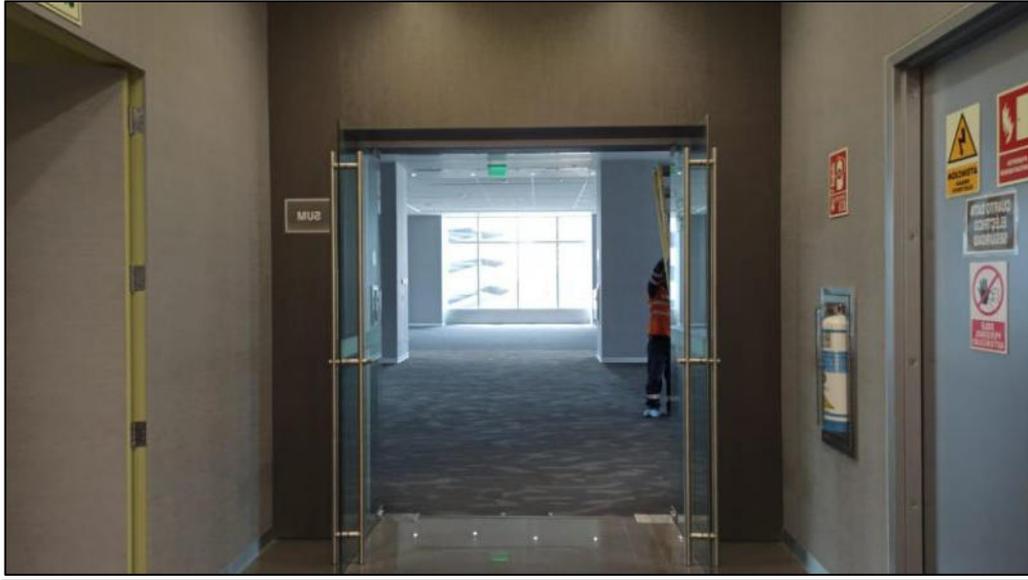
Se observa el área del hall de ascensores del piso 01 con acabados en muro laminadas en madera Alpi y enchape en muros con paneles alusión.
